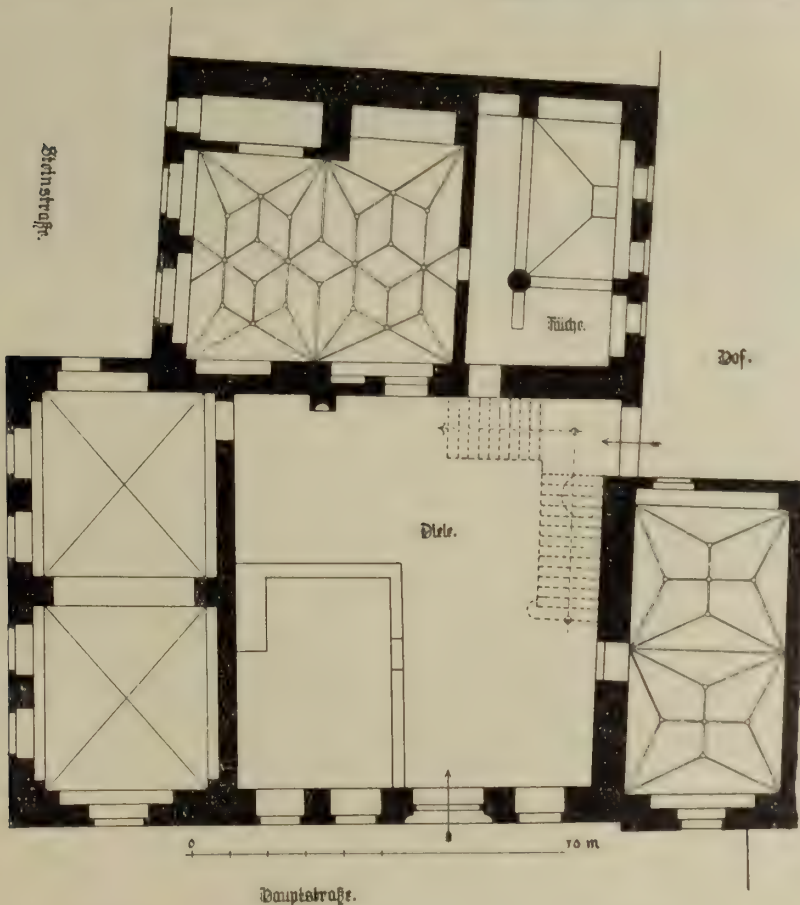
Erdgeschoßgrundriß des ehemaligen Hauses Störbeck.
